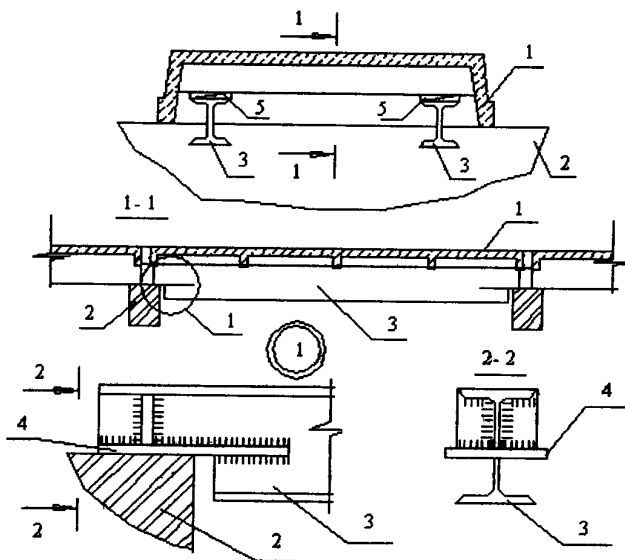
Підсилення поздовжніх ребер прокатними балками з підрізами на опорах: 1 – плита, що підсилюється; 2 – опорна конструкція; 3 – балка підсилення; 4 – опорна пластина; 5 – пластини-клинці
